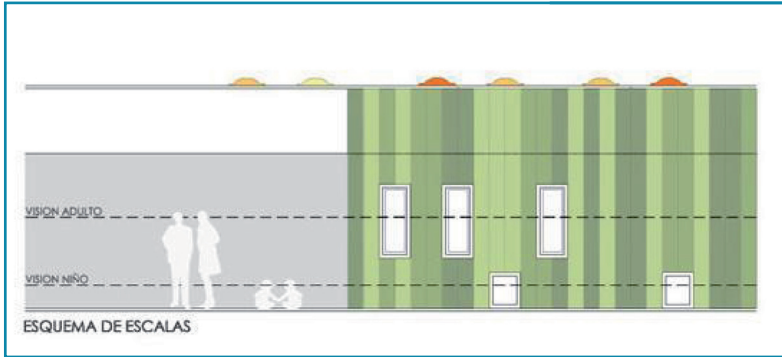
Esquema de escalas. Guardería en Viladecans, 2006.
